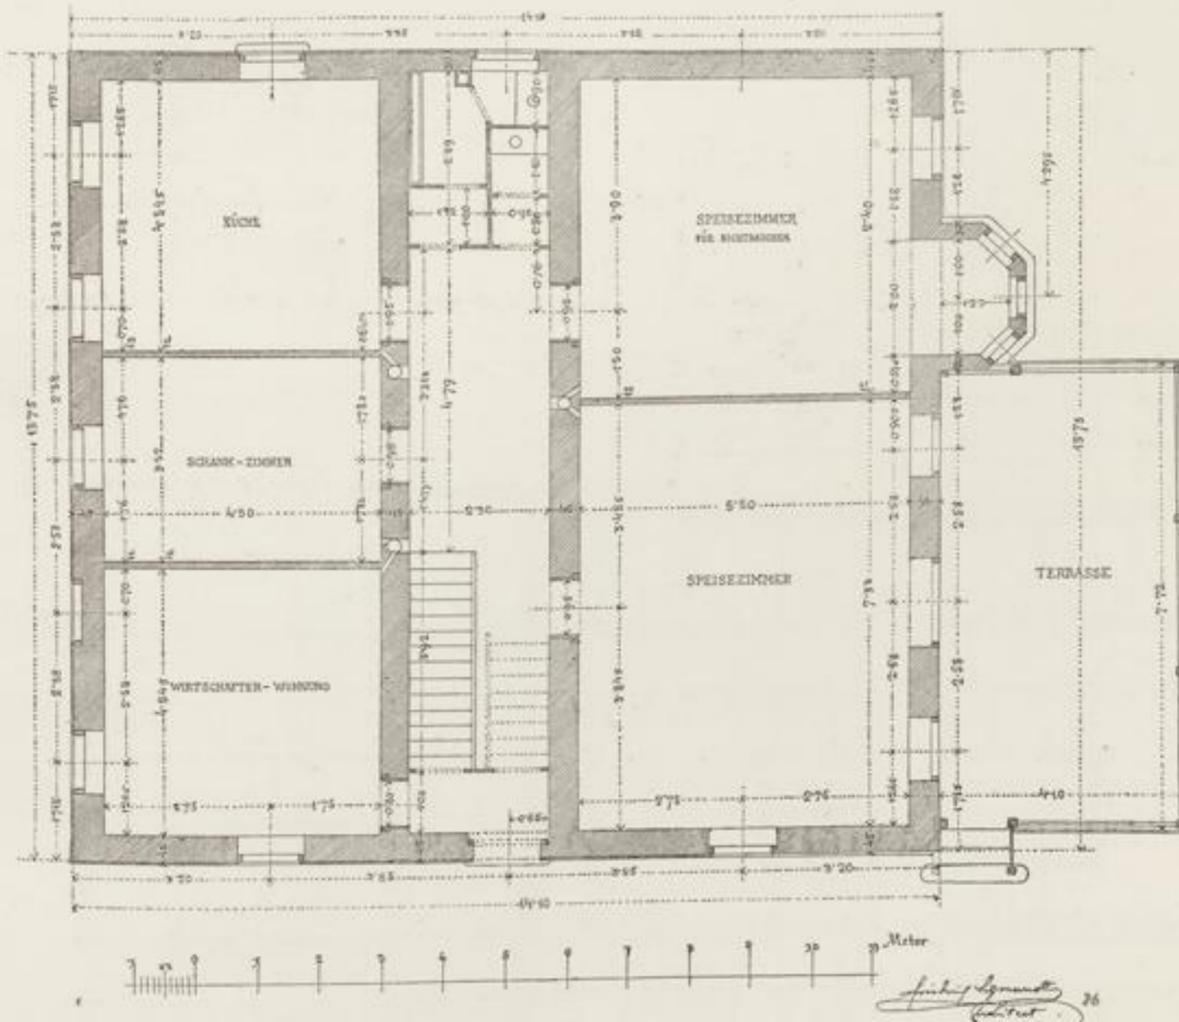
Dr. Fr. Schüler's Alpenhaus am Sonnwendstein. Grundriss vom Erdgeschoss.
